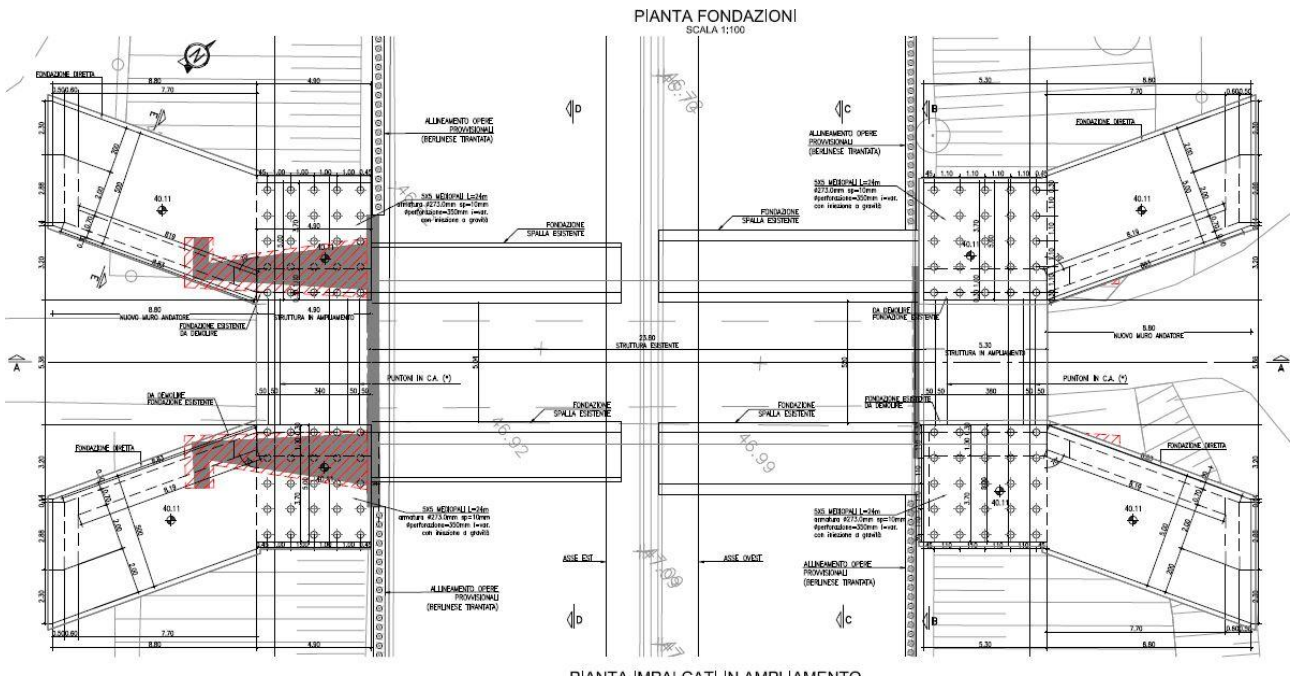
Planimetria di progetto opere di fondazione.
